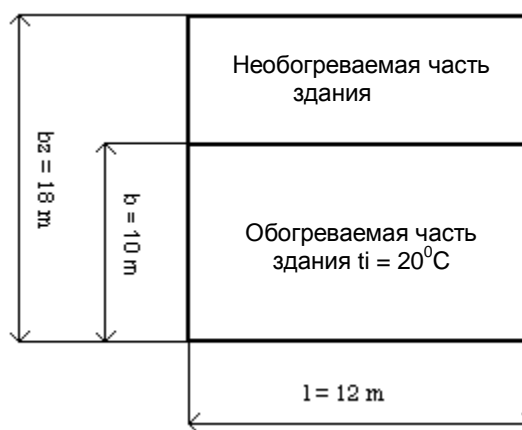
Горизонтальная проекция отдельно стоящего здания – первый этаж
